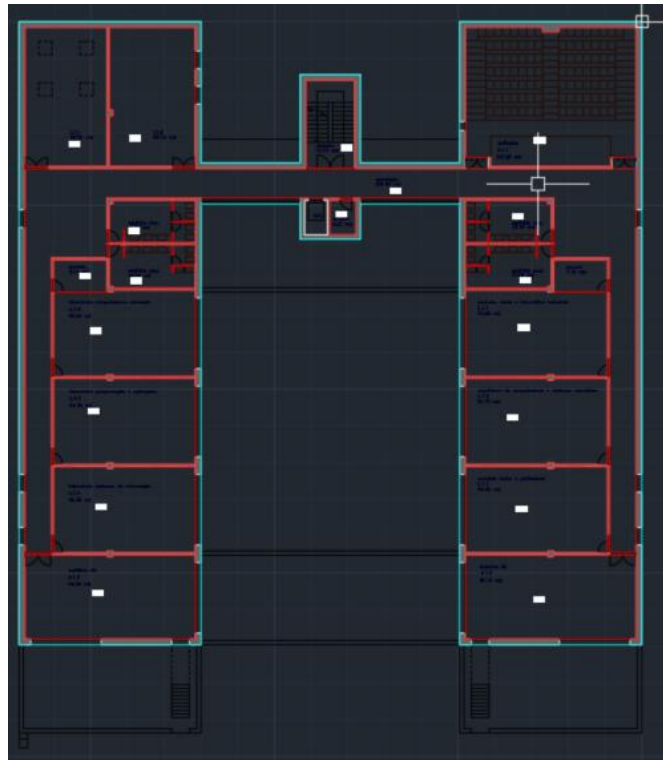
Planta do piso 1 do DEIS (AutoCAD, 2024).
